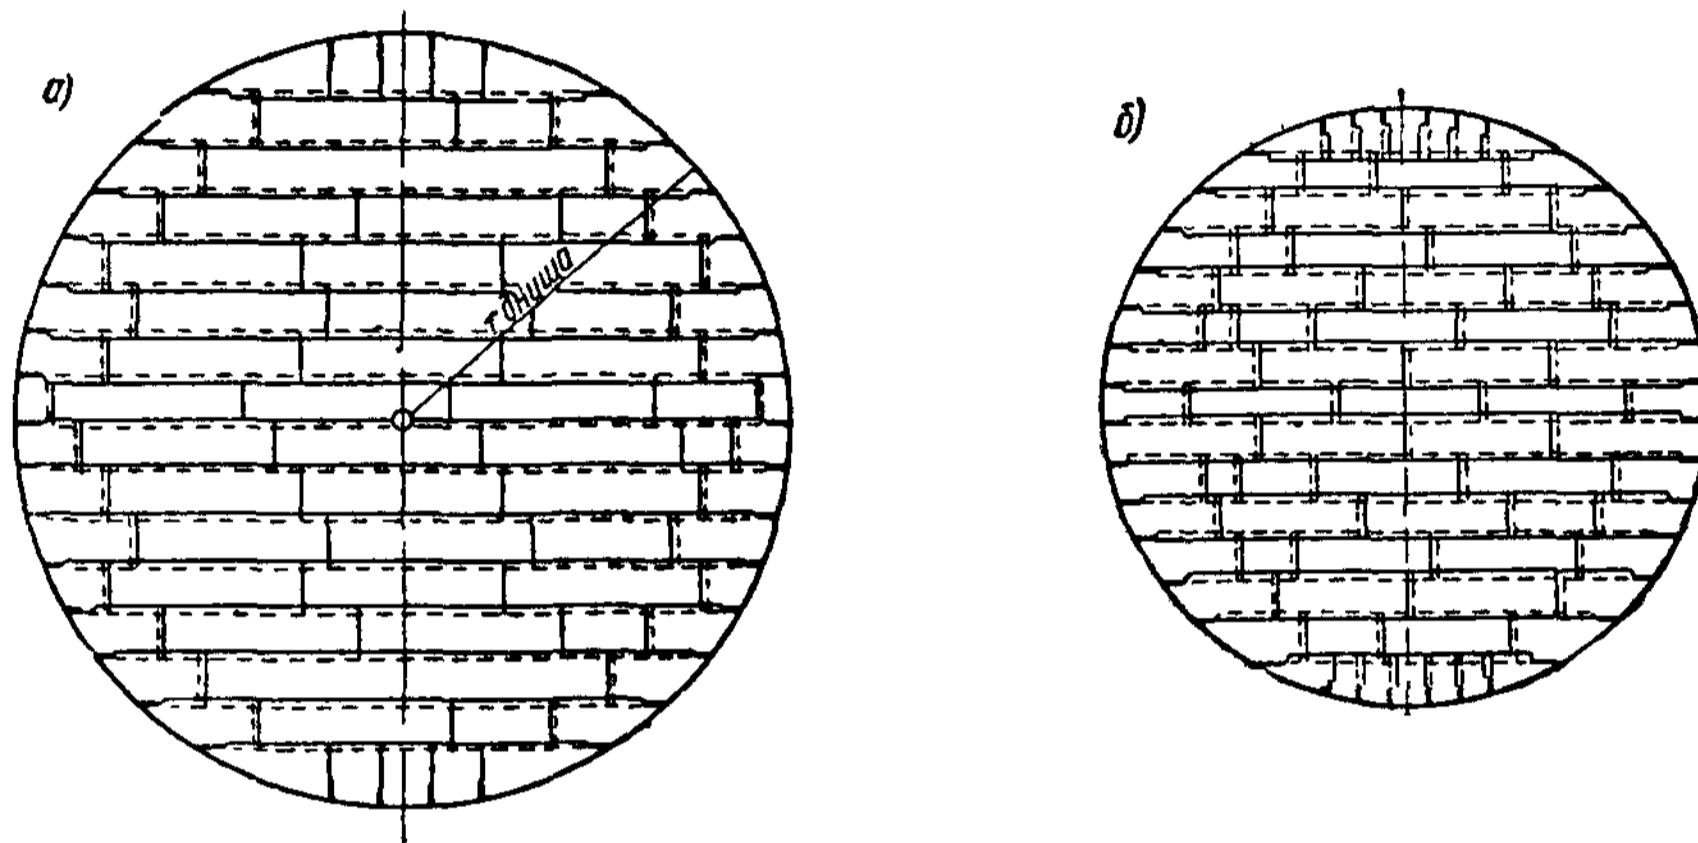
Конструкция плоского днища вертикального цилиндрического резервуара
